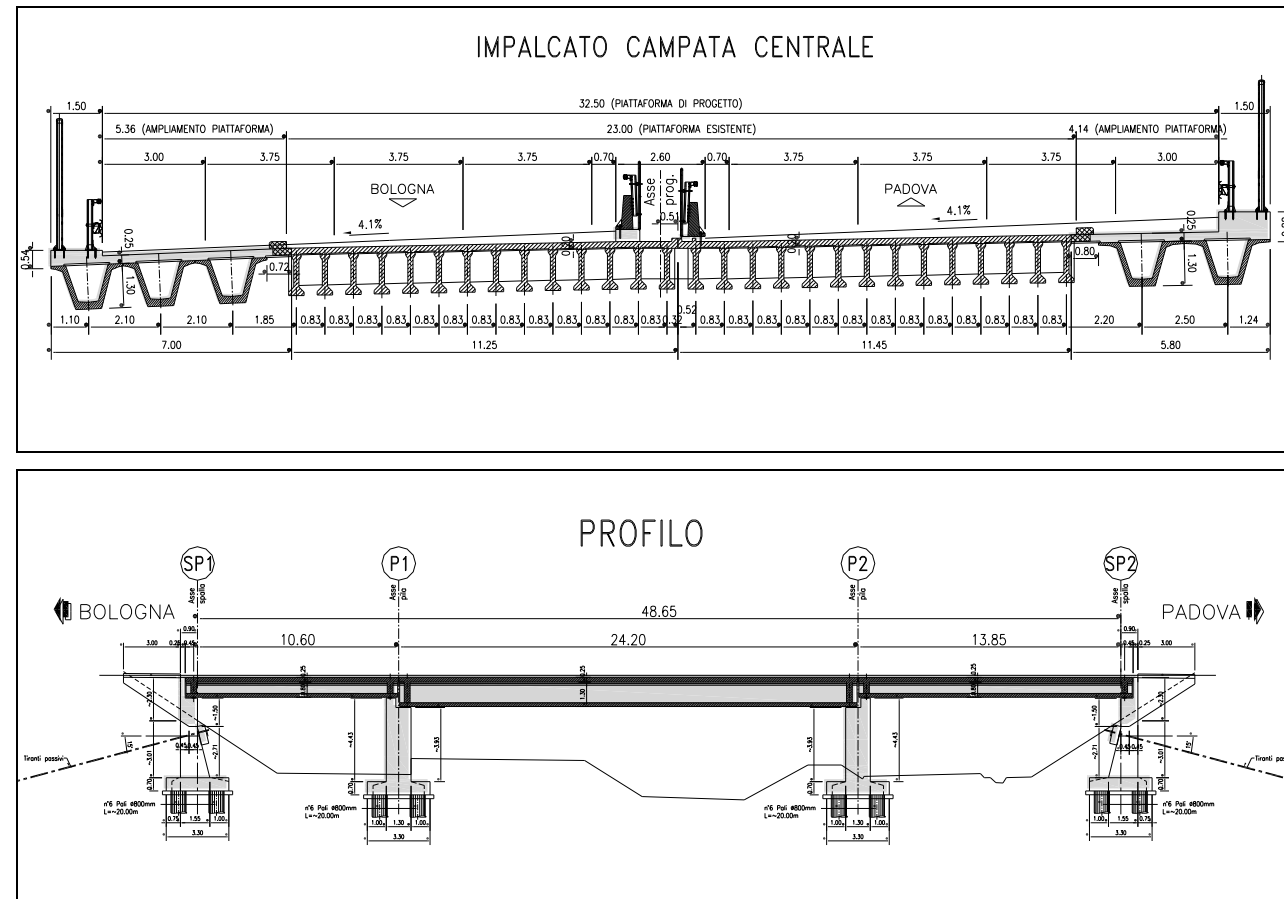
Sezione dell'impalcato e profilo del ponte sul canale Biancolino
